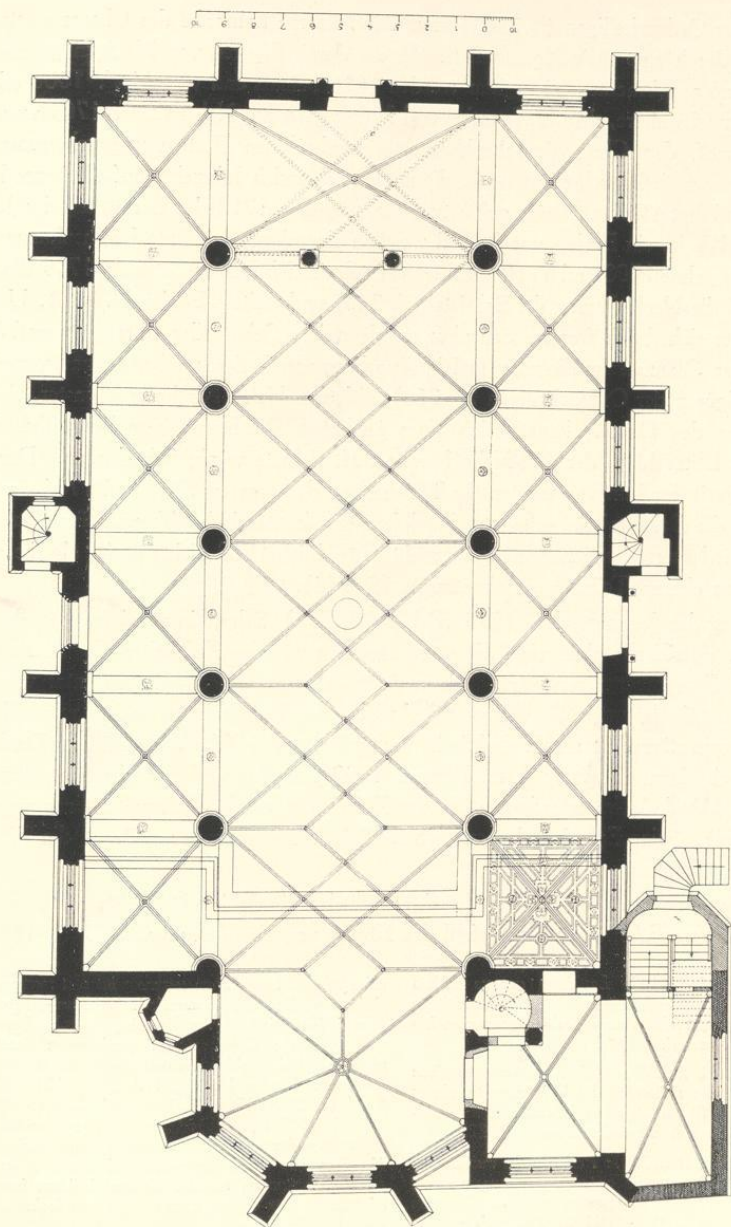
Grundriß der St.-Petri-Kirche: Norden unten
